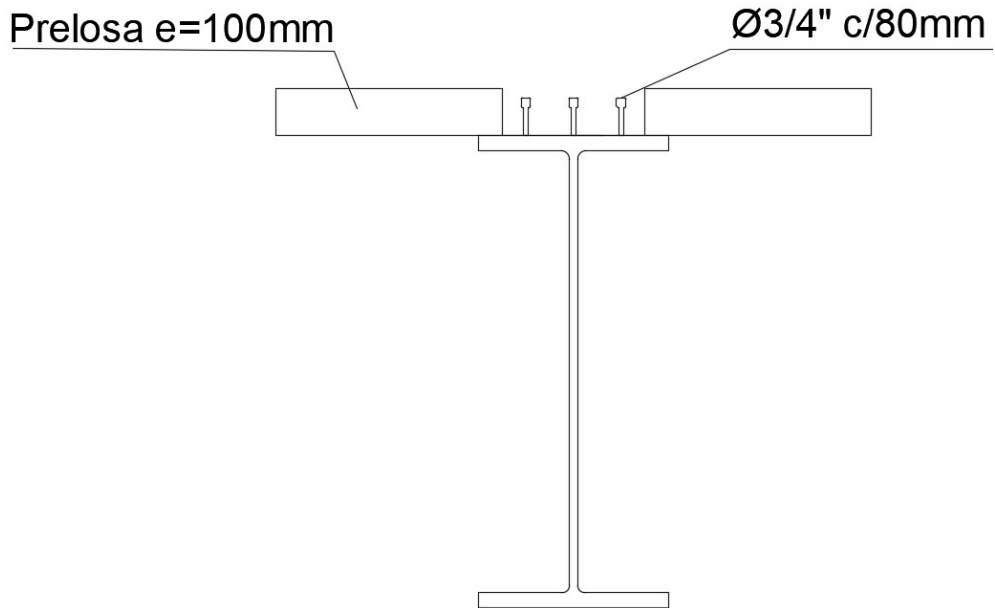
Detalle de la unión entre las vigas longitudinales externas y la losa del tablero.
